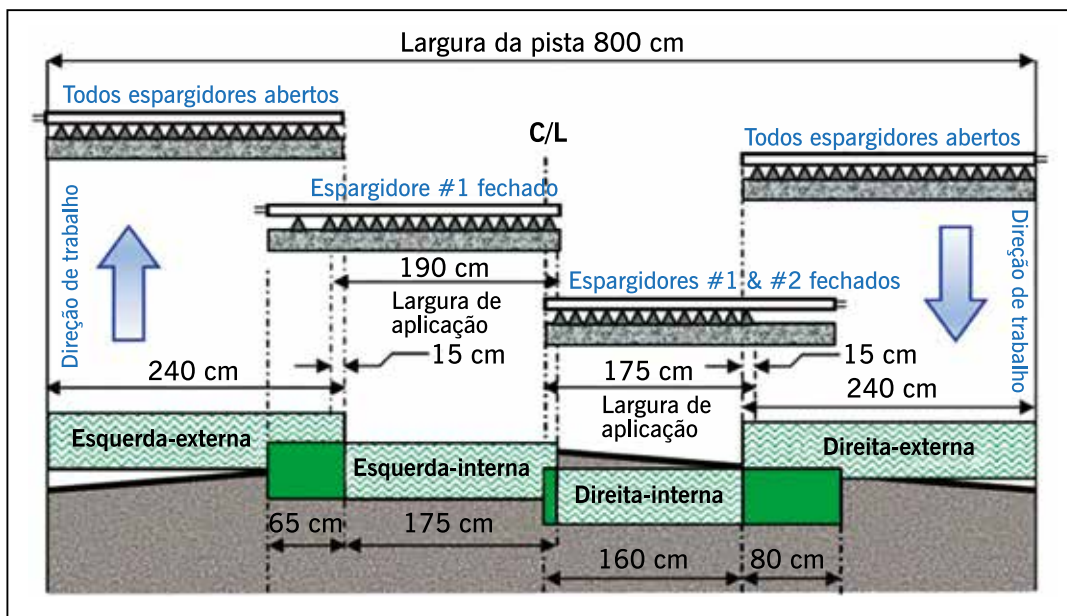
Exemplo de plano de corte em pista de 8,0 m de largura (Sabita, 2020)
